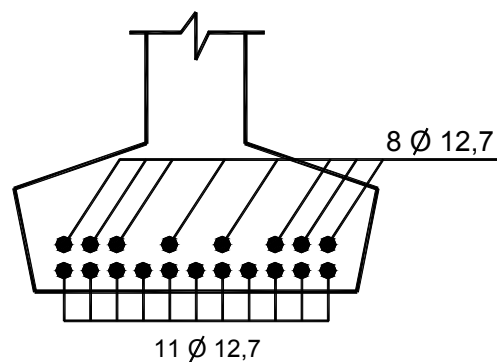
Armadura de flexão da aplicação nº 3.
